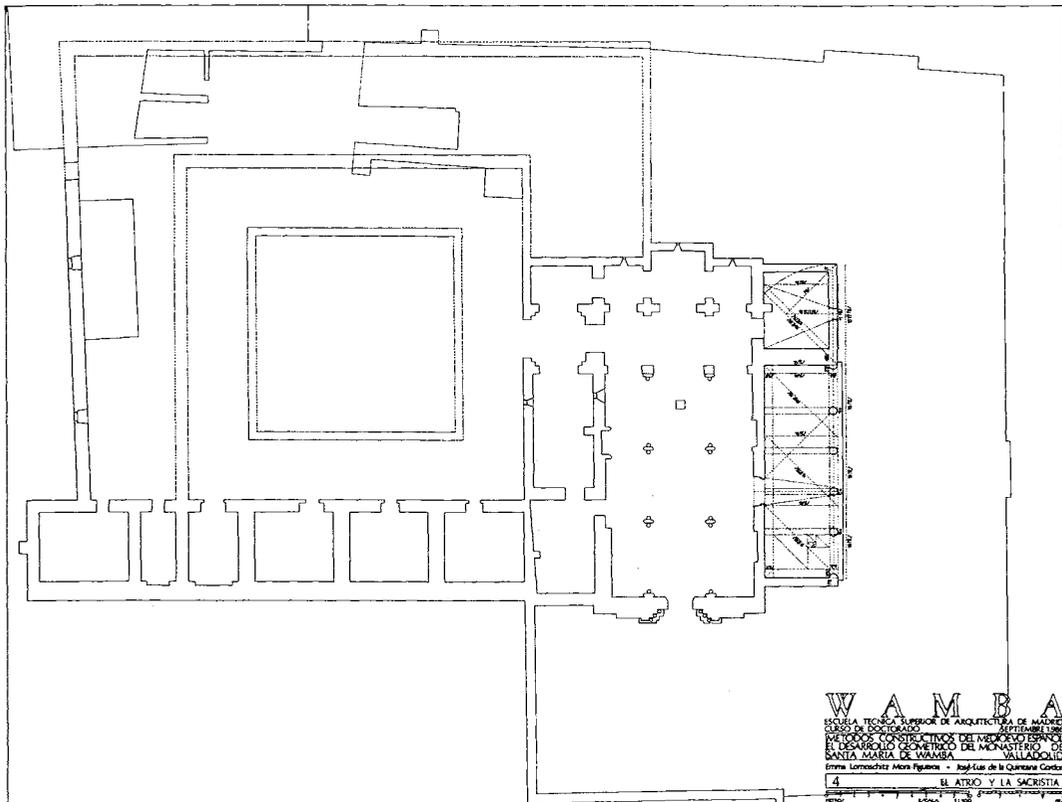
d.—SIGLO XVIII: La planta del atrio se forma por adición de 3 cuadrados de 21 pies castellanos de lado (1 pie castellano = 0,28 m). La planta de la sacristía es de  $21 \times 21\sqrt{2}$  pies.
